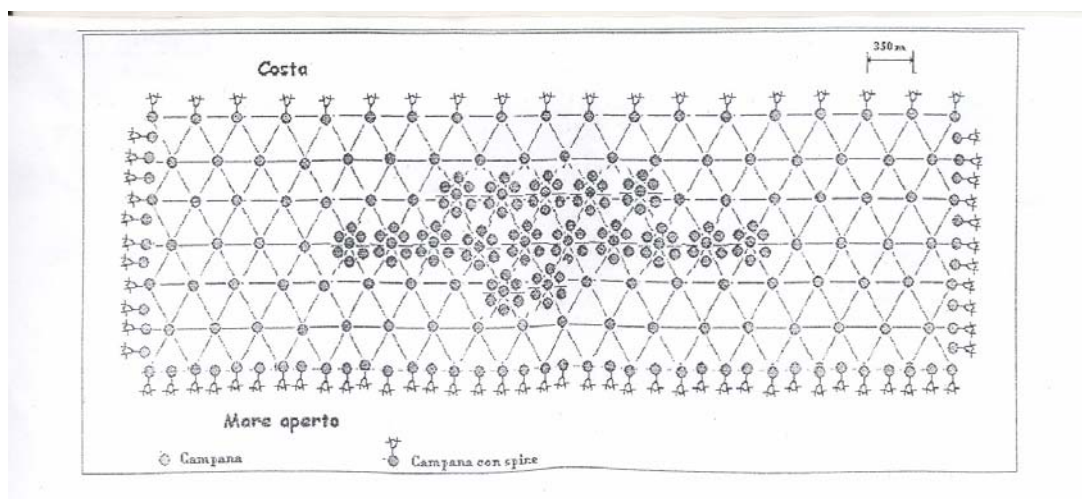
Disposizione a “quinconce” delle campane in calcestruzzo.
